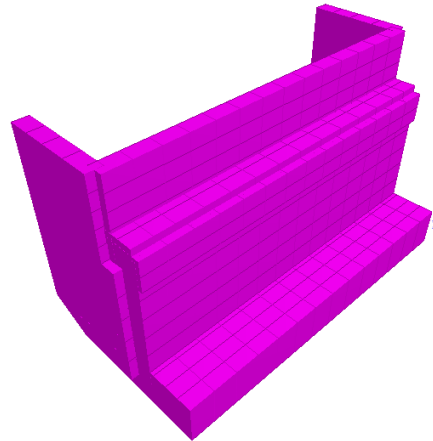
3D Rendering Geometri Struktur Atas pada Software STAAD.Pro CONNECT Edition
